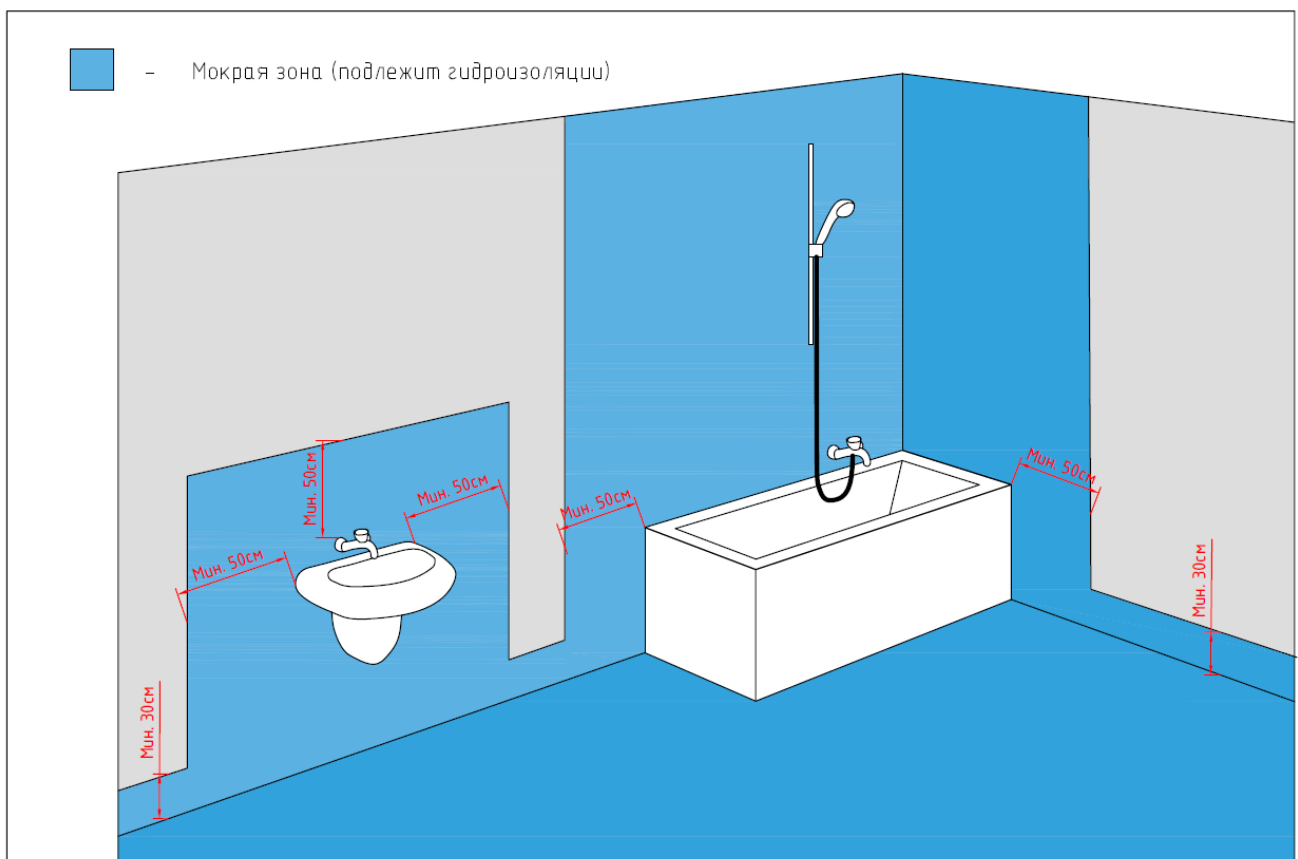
Мокрые зоны внутри влажных помещений, подлежащие гидроизоляции.
